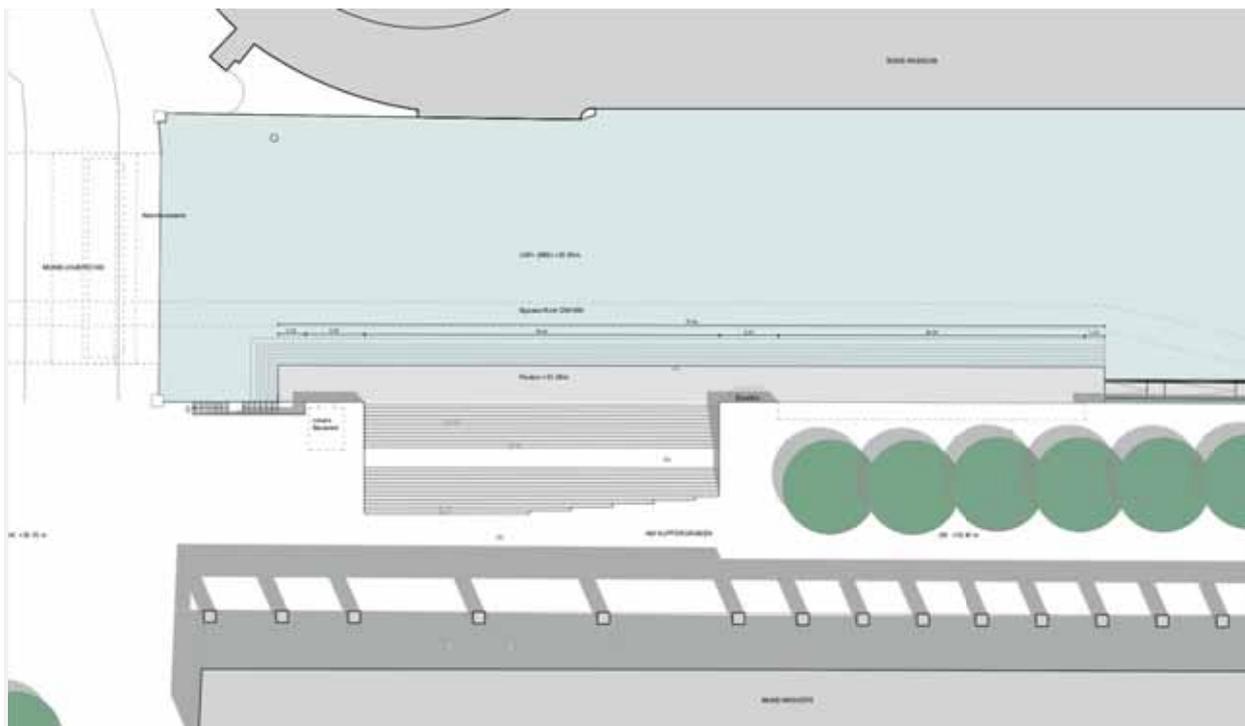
Grundriss "permanenten" Wasserzugang Monbijoubrücke mit Neubau "Museumshöfe" und bei Umwidmung der Straße Am Kupfergraben (LP_9_Monbijou_PermAnl_200.pdf)
